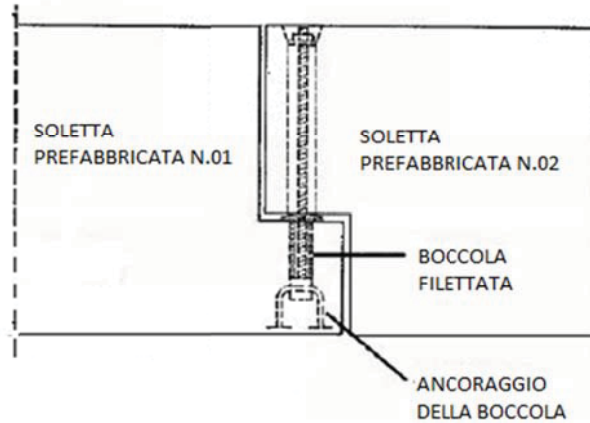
Collegamento fra le solette costituenti la platea di fondazione.
